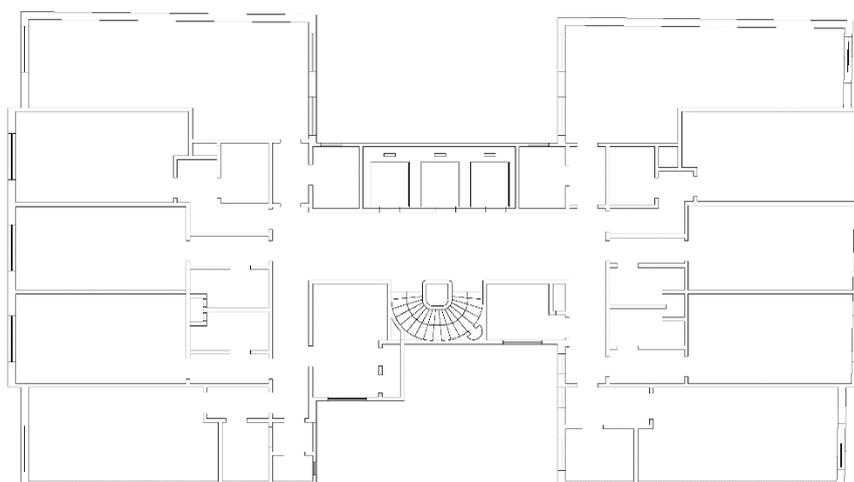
Planta tipo, projeto original. Fonte: COHAB
